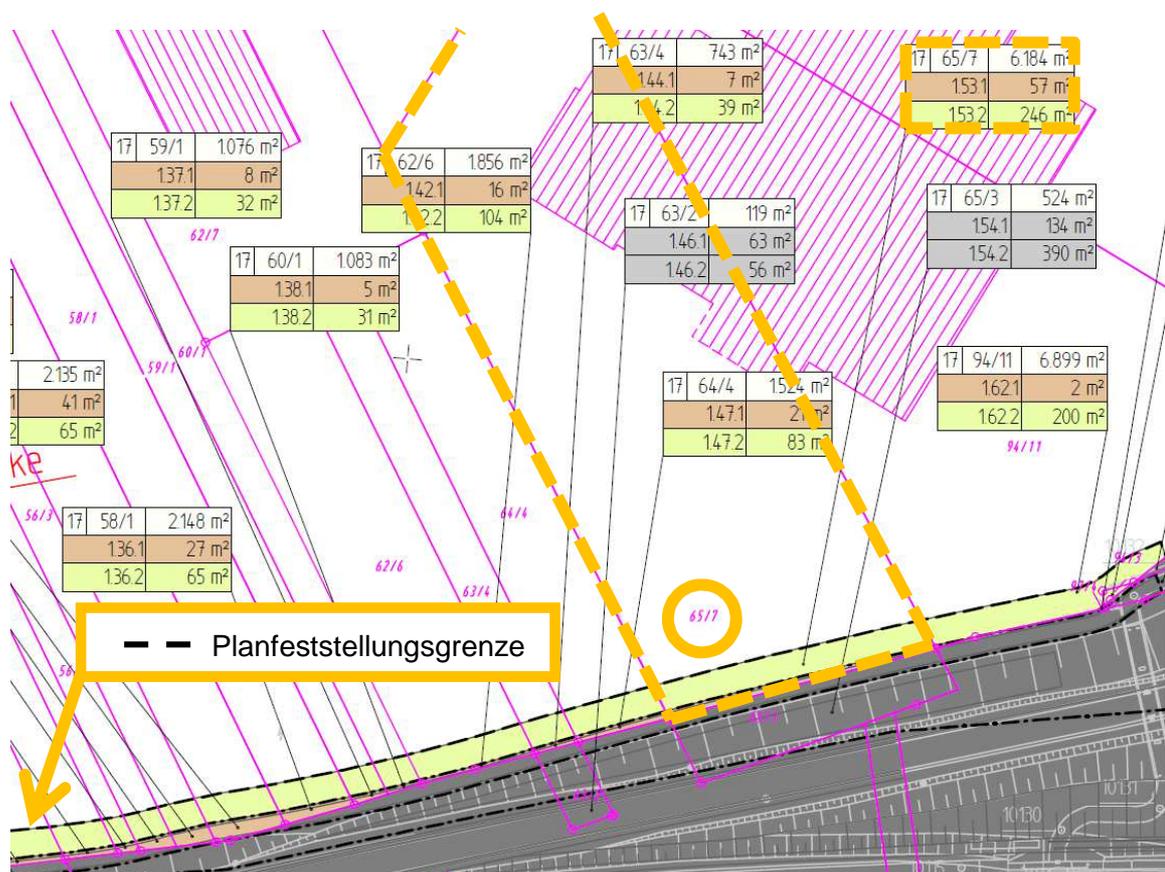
Auszug aus einem Grunderwerbsplan – Beispiel: Flurstück 65/7 (Unterlage 10.1)
